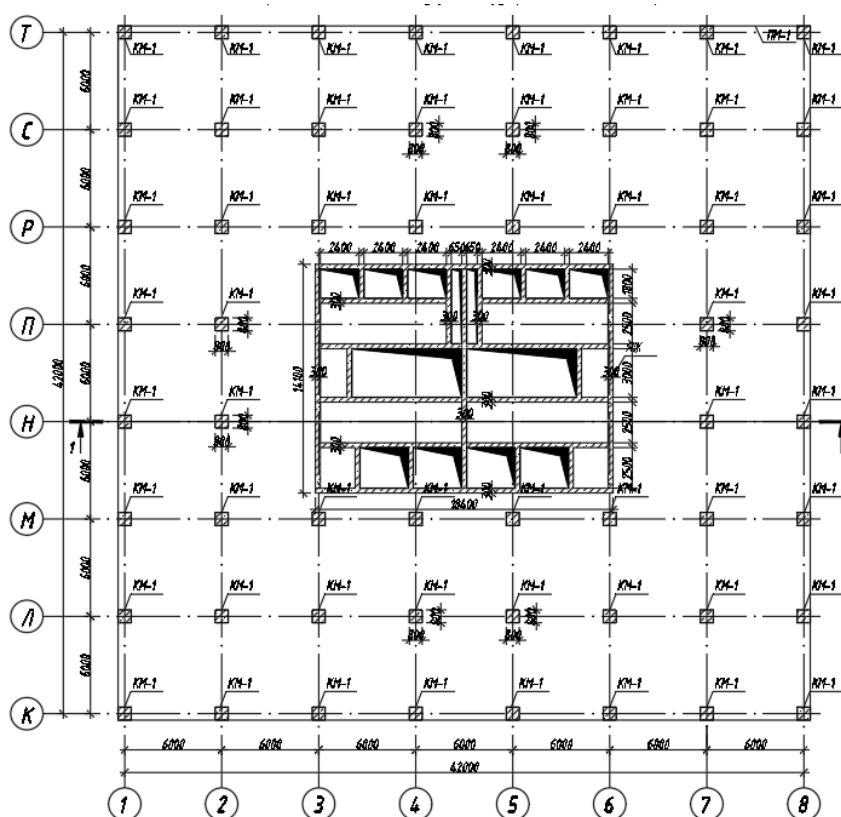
Схема расположения несущих элементов железобетонного каркаса здания
